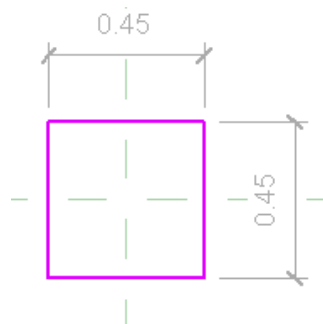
Extrusión de a base del pilar. Fuente: Elaboración Propia.
